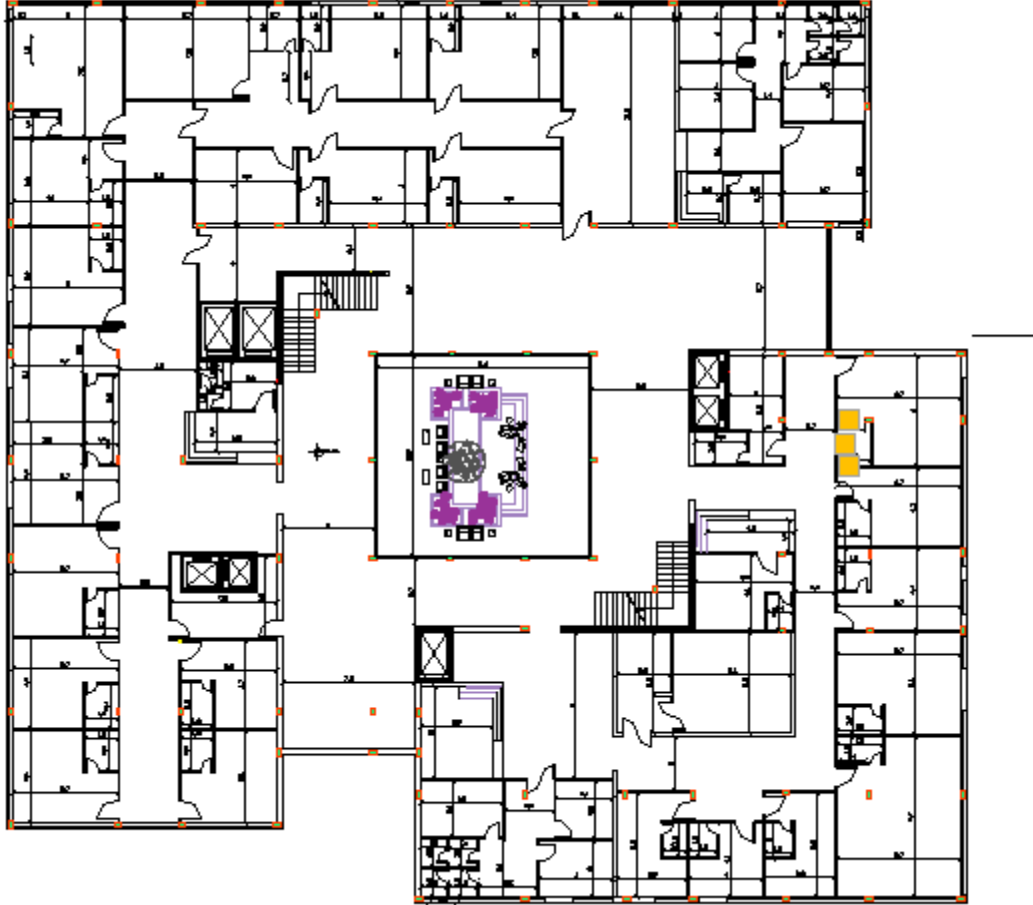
المسقط الأفقي للطابق الأول.
